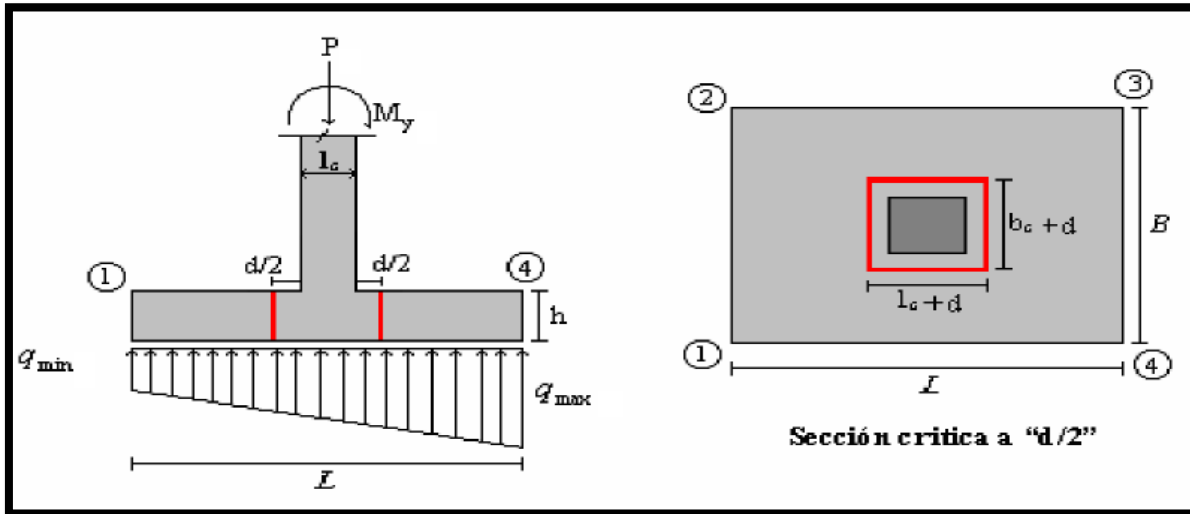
Esquema de zapata concéntrica con sección crítica para cálculo de cortante por punzonamiento.
